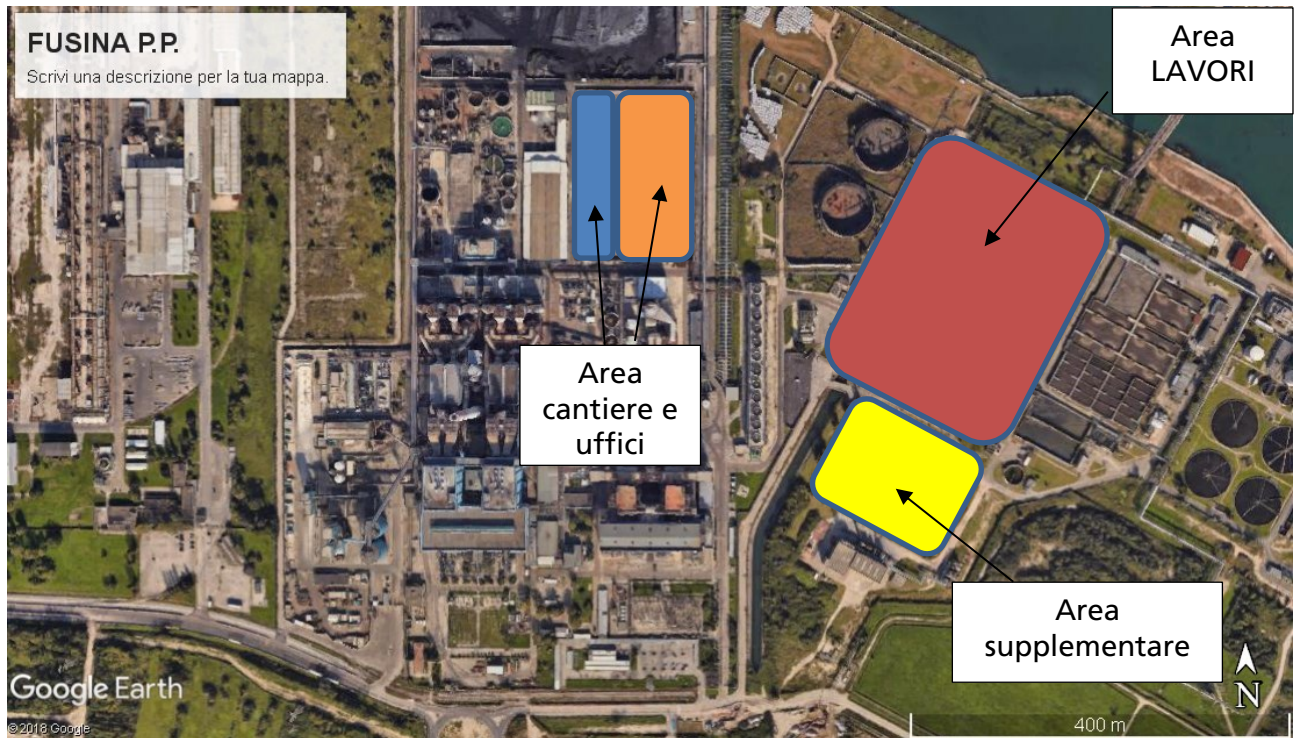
Rappresentazione delle aree di cantiere previste
